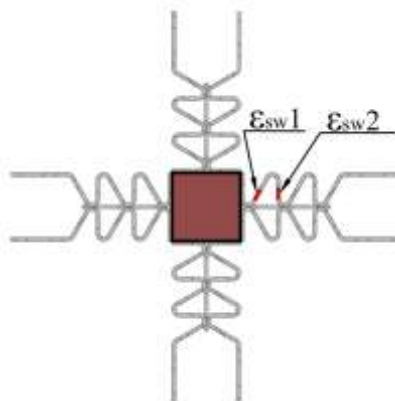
Disposição dos ϵ_{sw1} nas armaduras de cisalhamento da laje L1
